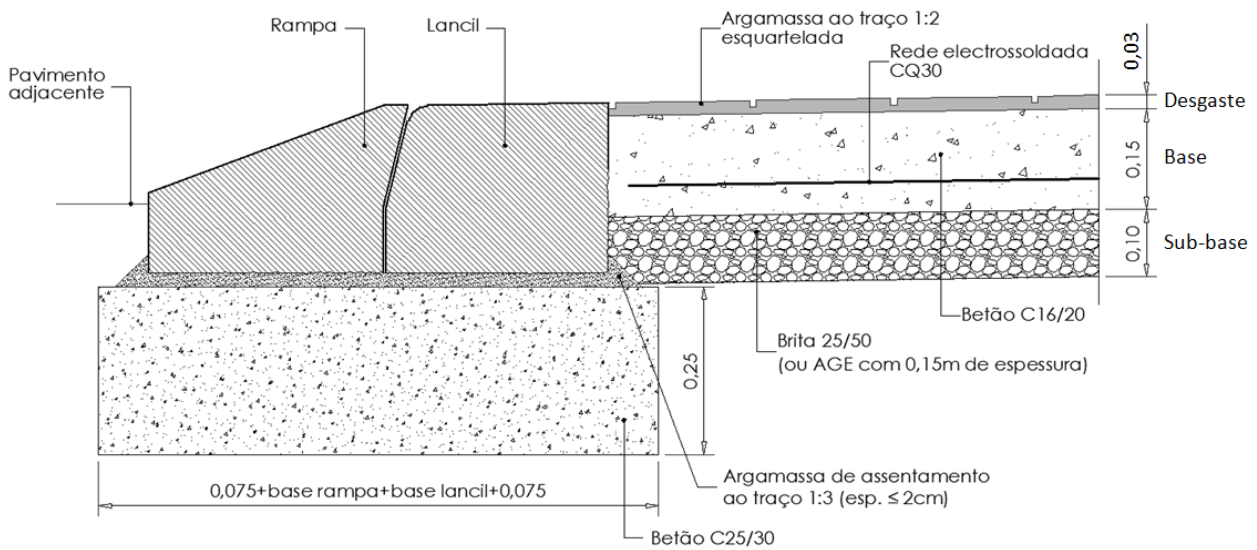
Pormenor construtivo de um passeio em betonilha esquarelada de zona traficável (adaptado de C. M. do Porto, 2017).
